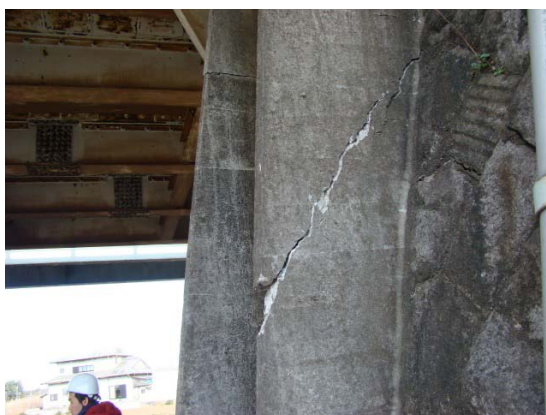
A 1 橋台左側面のひび割れ
